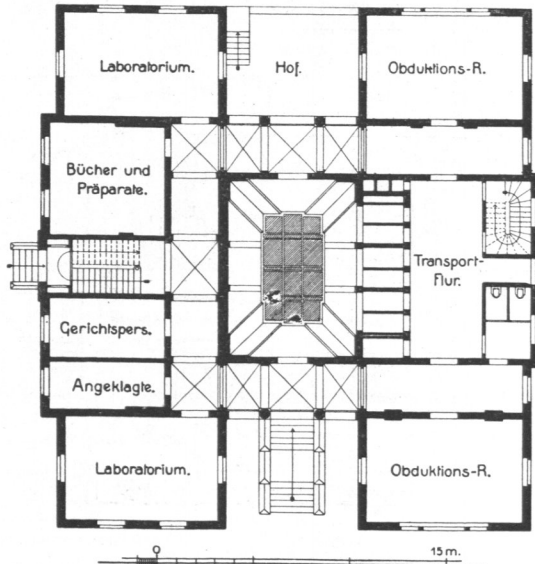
Hafenkrankenhause, Leichenschauhause und Anatomie, Erdgeschoß, Grundriß.
